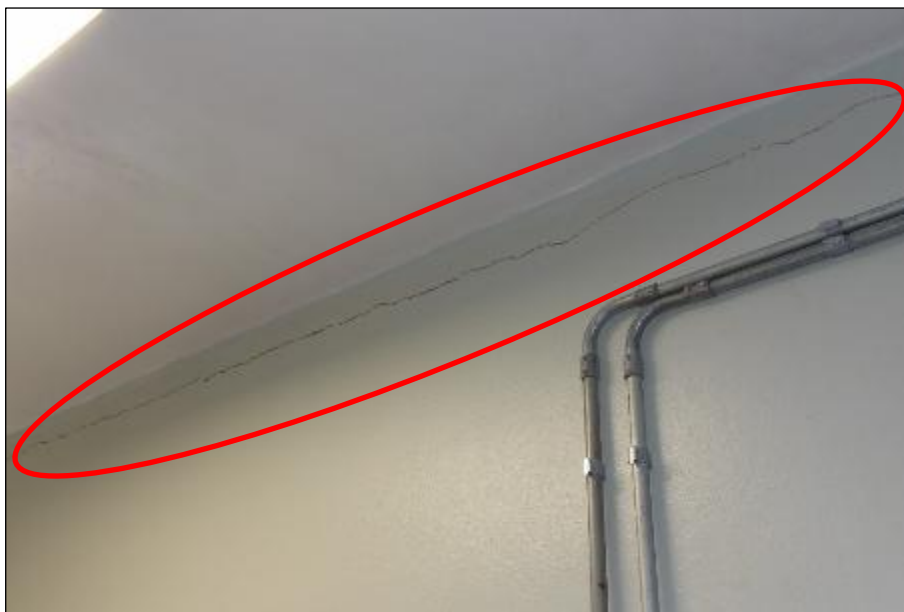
Fissura horizontal na região de encontro da alvenaria com a laje.
